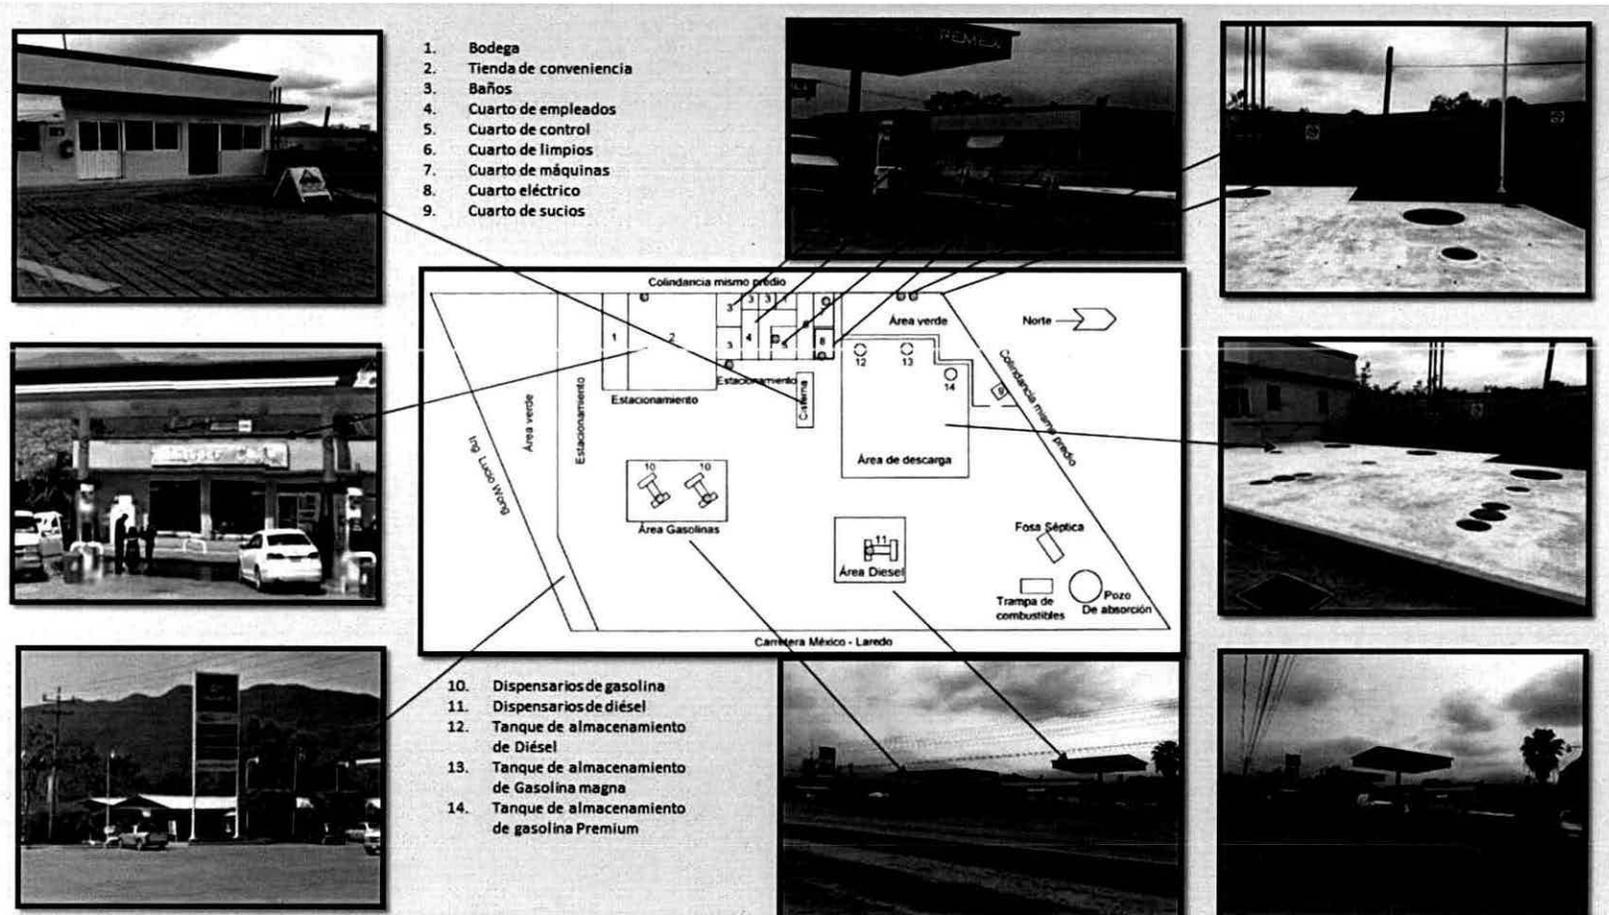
PLANO GENERAL DE LA INSTALACIÓN
